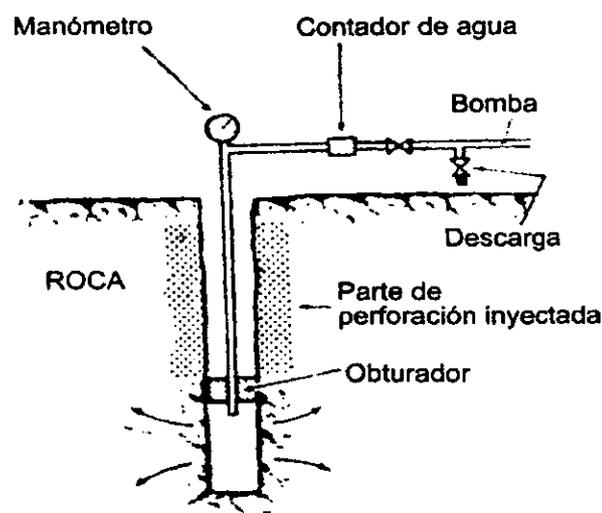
Montaje del equipo para la realización de la prueba LUGEON.
